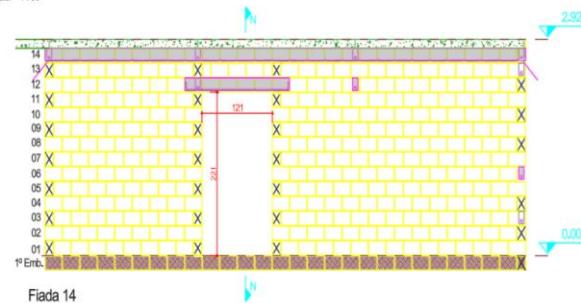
Vista parede (Fonte: TECOL projetos) Em cinza onde vai ser grauteado e armado.
